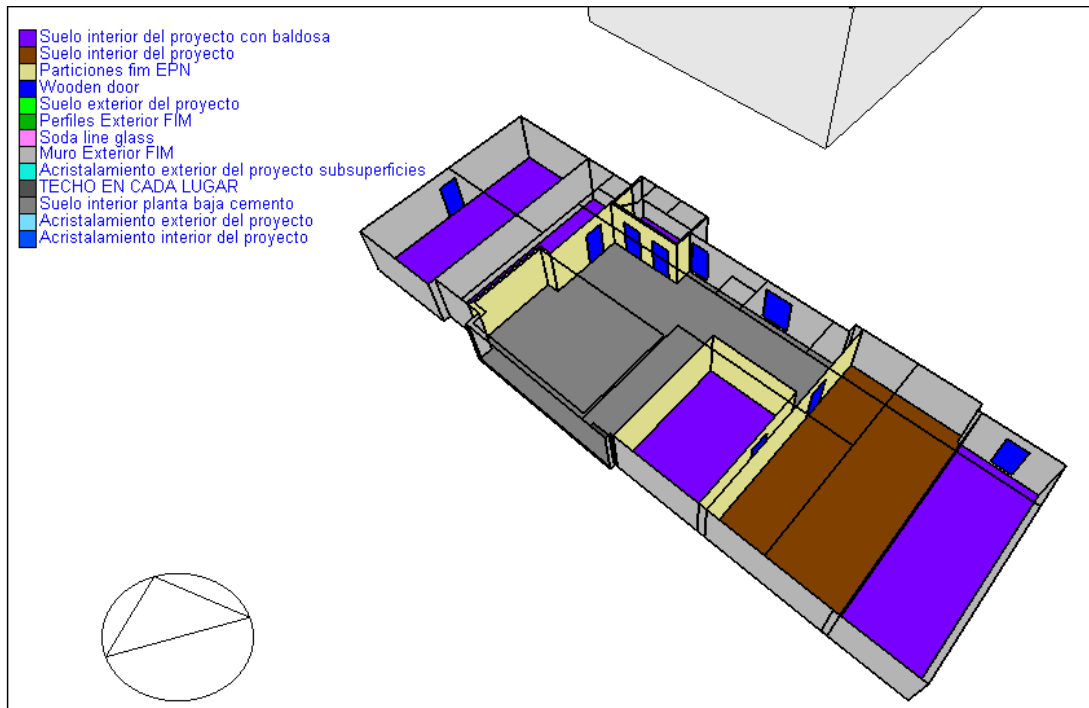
Modelo de la planta baja (vista axonométrica) de la Facultad de Ingeniería Mecánica en *DesignBuilder
